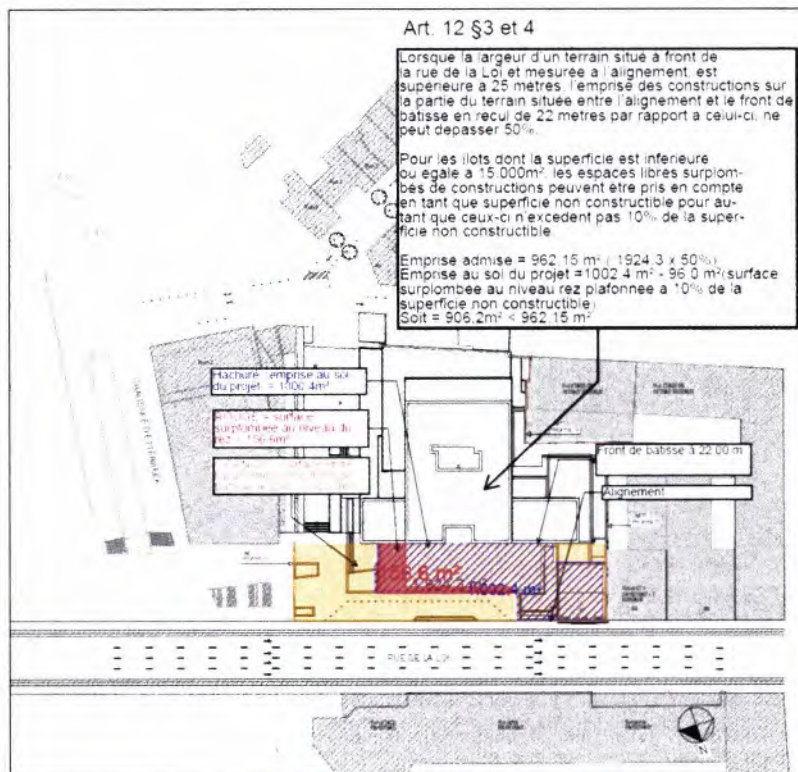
Emprise des constructions sur la devanture (source : ASSAR Architectes)
